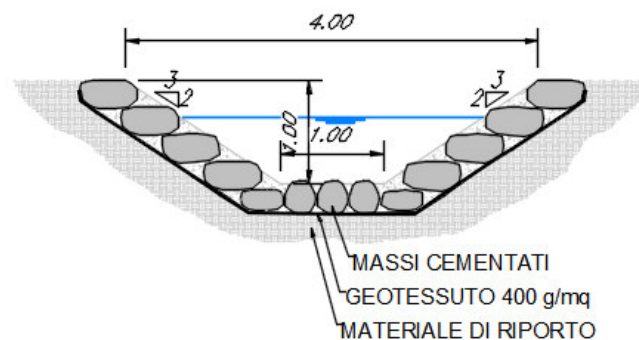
Corso d'acqua IN02_ Sezione tipo sistemazione
